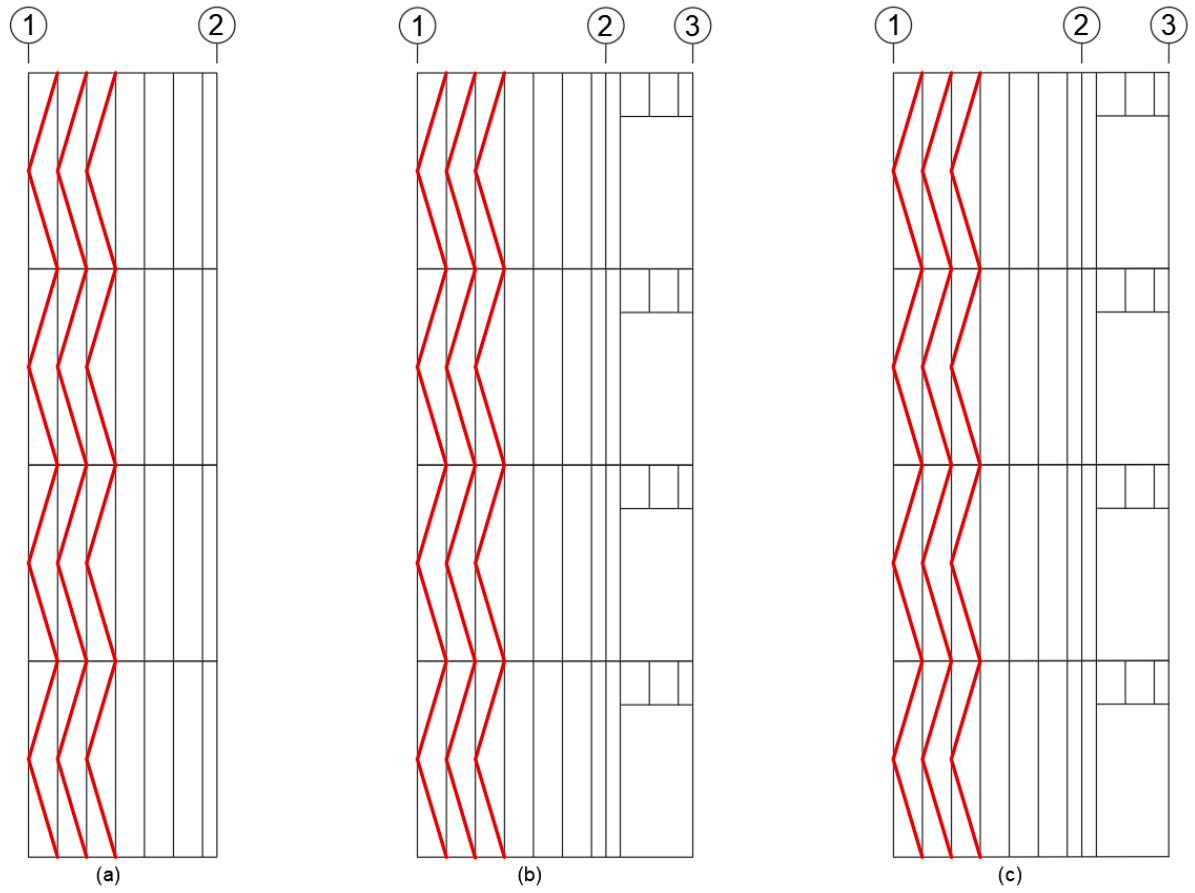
(a) Elevação D/L, (b) Elevação E/K e (c) Elevação F/L do Contraventamento K
